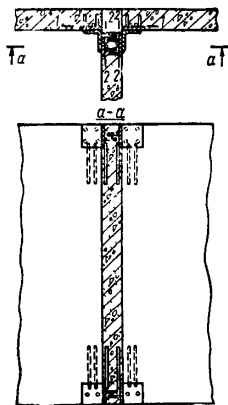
Соединения стен с помощью сварки закладных деталей
